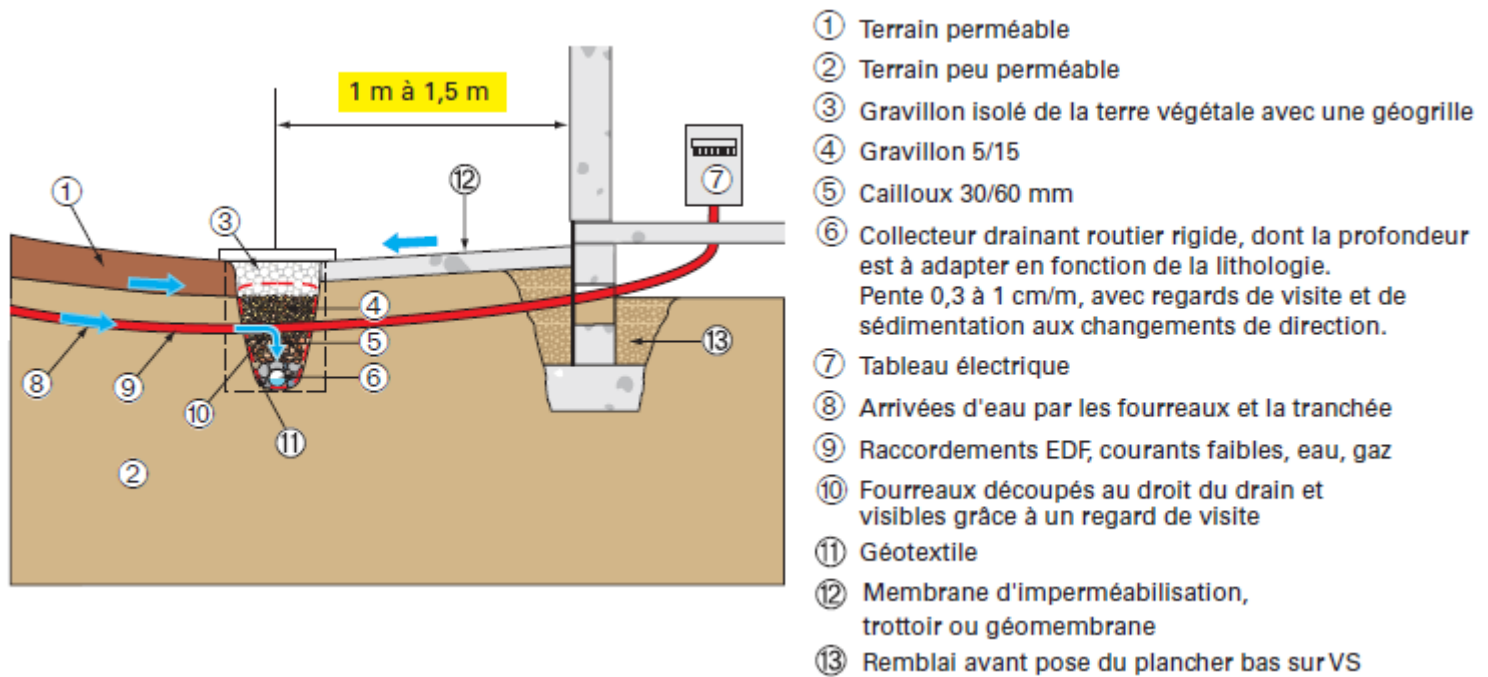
Implantation d'une tranchée drainante et d'une imperméabilisation périphérique (Béchade, 2021)
